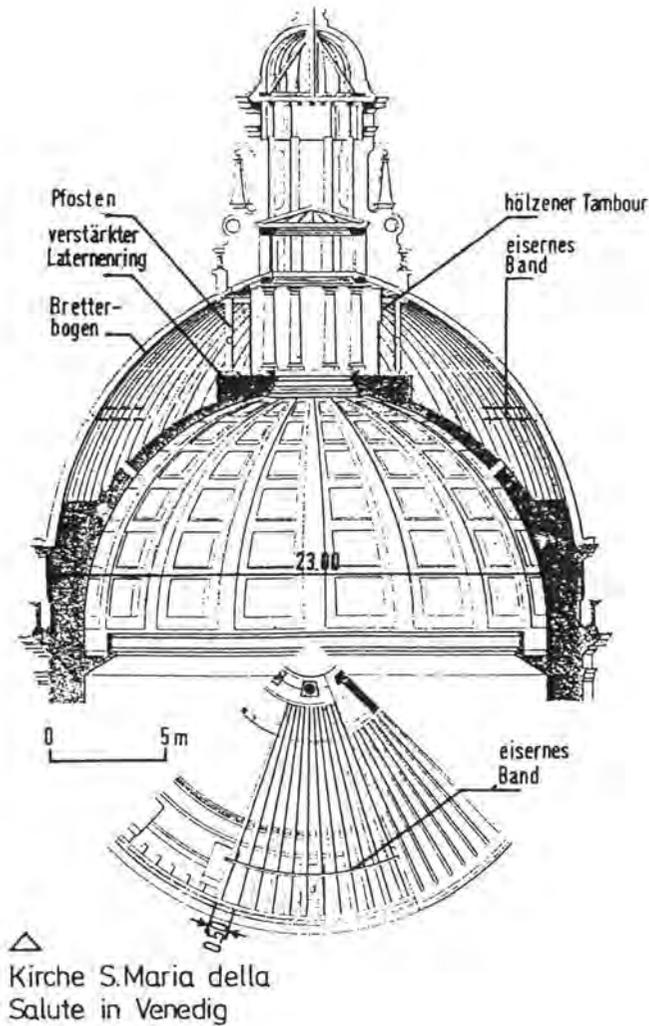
Venedig, Kirche S. Maria della Salute, Grundriss und Schnitt, aus /36/
